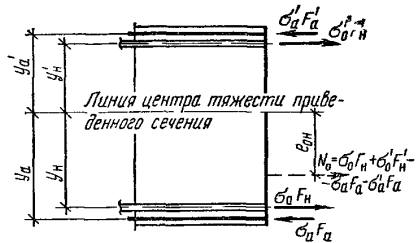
Схема усилий предварительного напряжения арматуры в поперечном сечении железобетонного элемента
